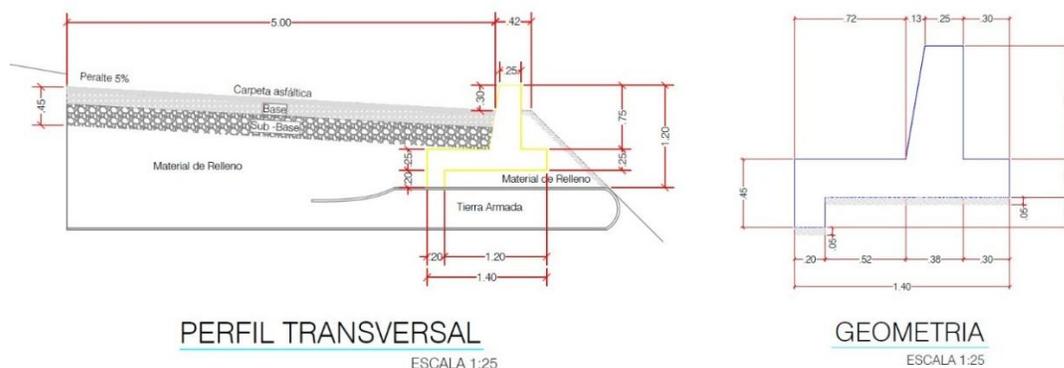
Detalle de Perfil transversal y Geometría del Muro de Contención Vía Interna. Fuente Diseño Ing. Pablo A. Ramírez B.
